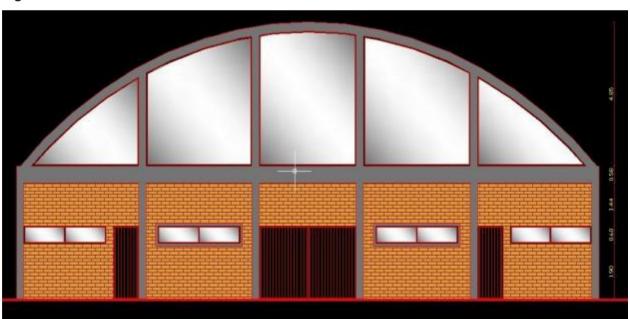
Vista en planta. Modificación de medidas y aumento de detalles
